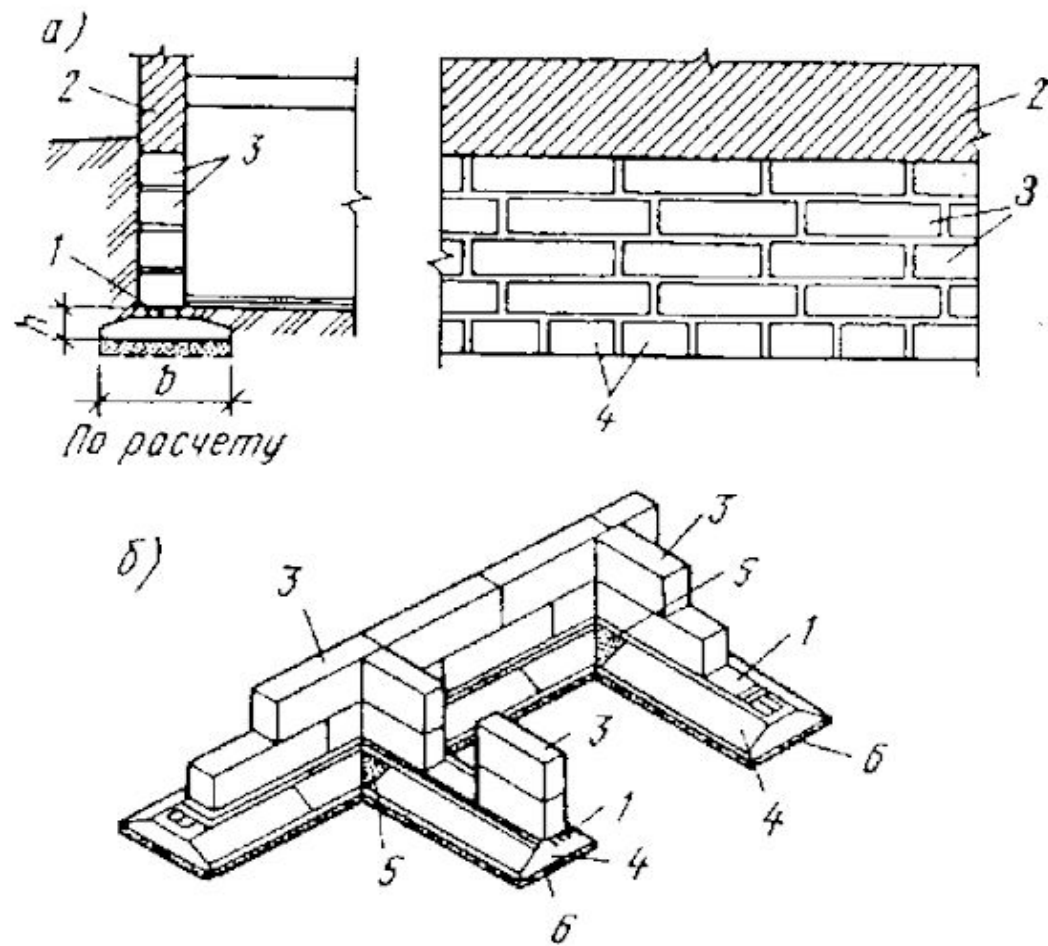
Ленточный сборный фундамент из крупных блоков:
